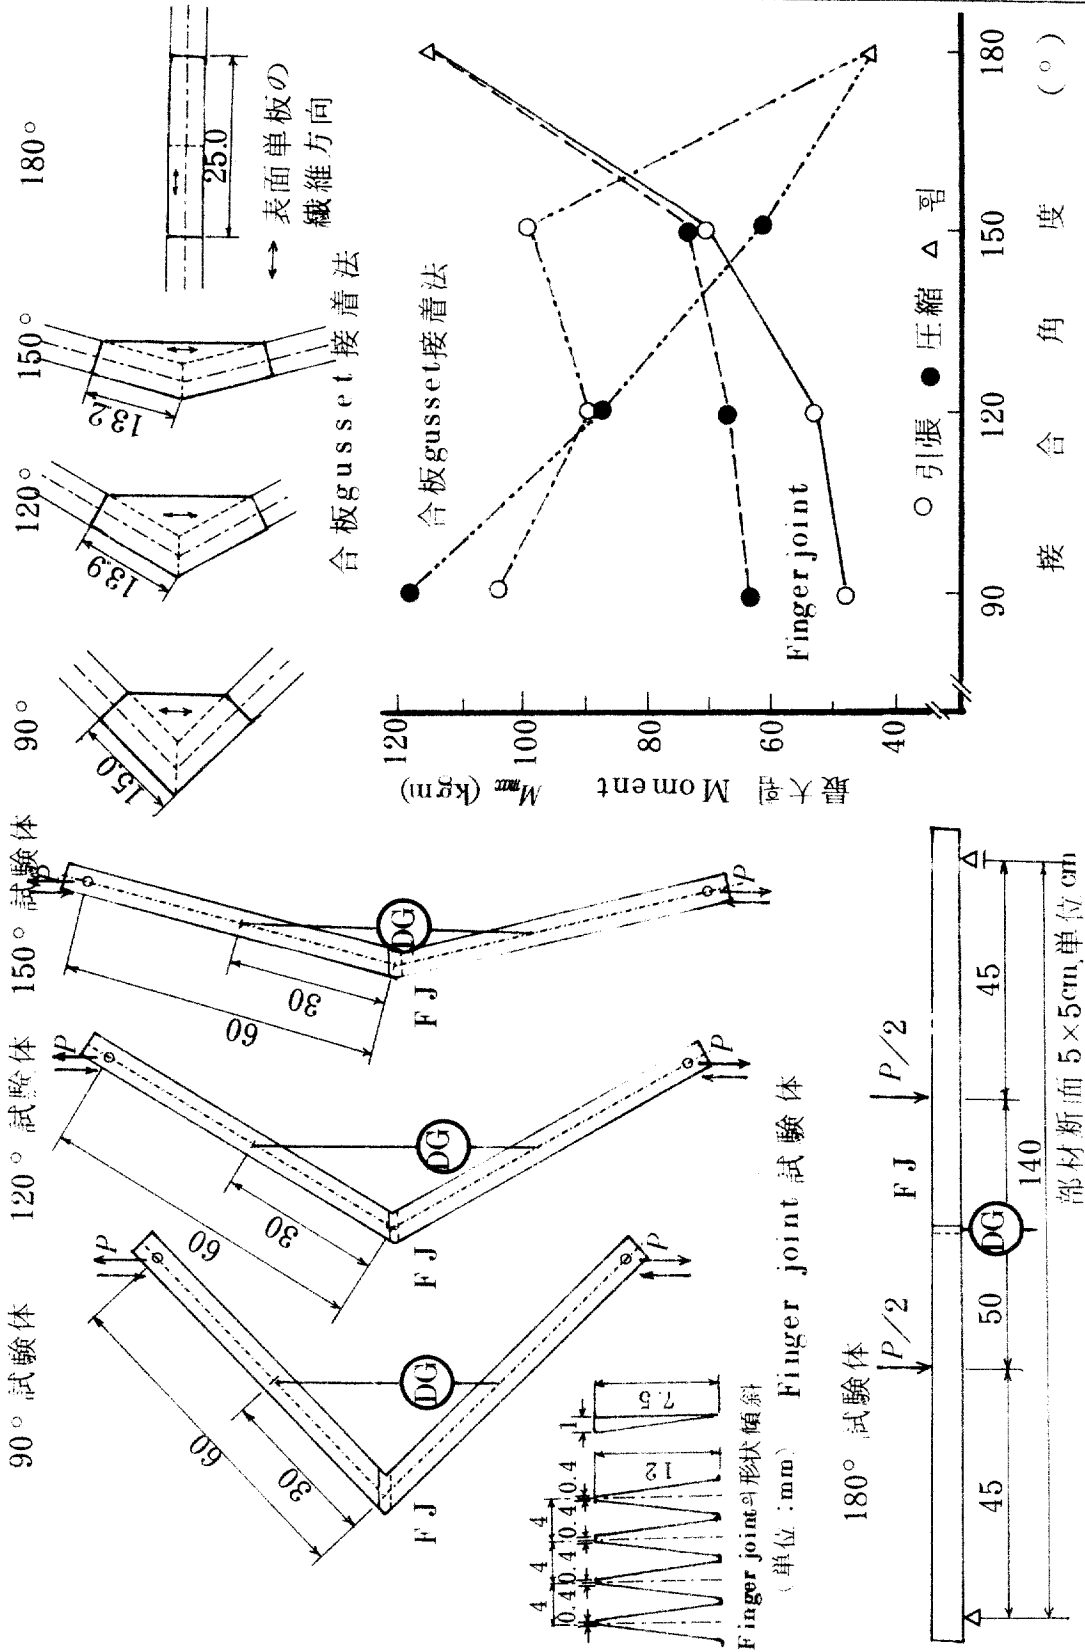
合板gusset 接合法 및 finger joint 에 의한 各種 角度의 接合試驗體 및 試驗結果.
